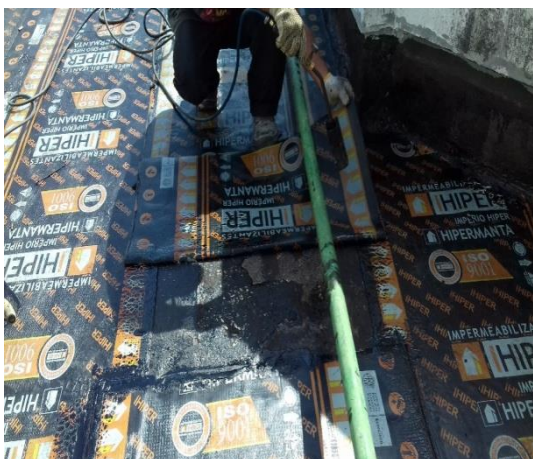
Aplicação da manta asfáltica 4mm.Fonte. Autor, 2018.
